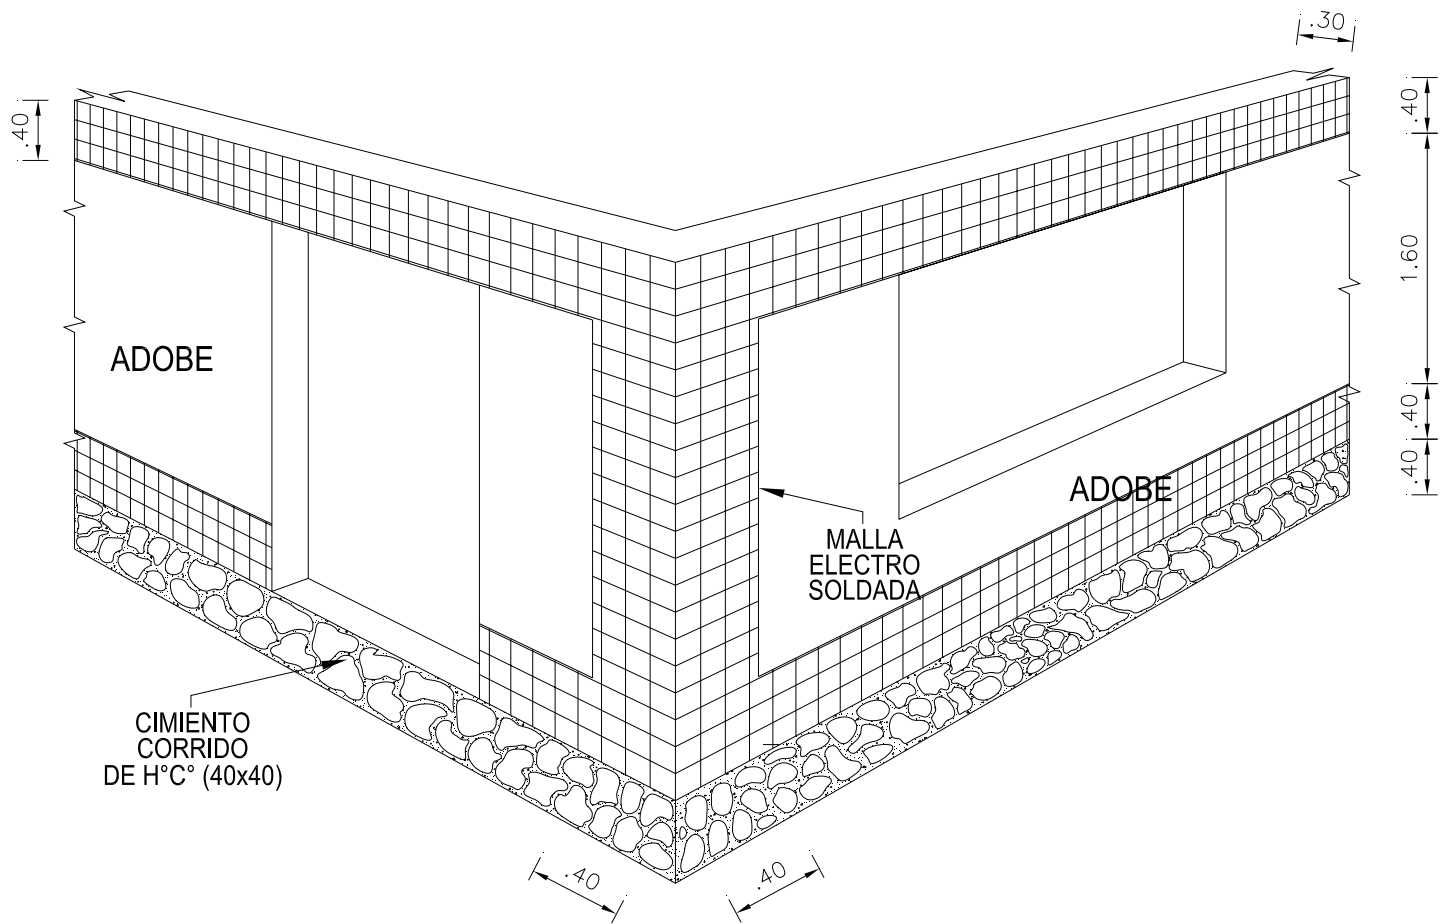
REFUERZO CON MALLA ELECTRO SOLDADA
